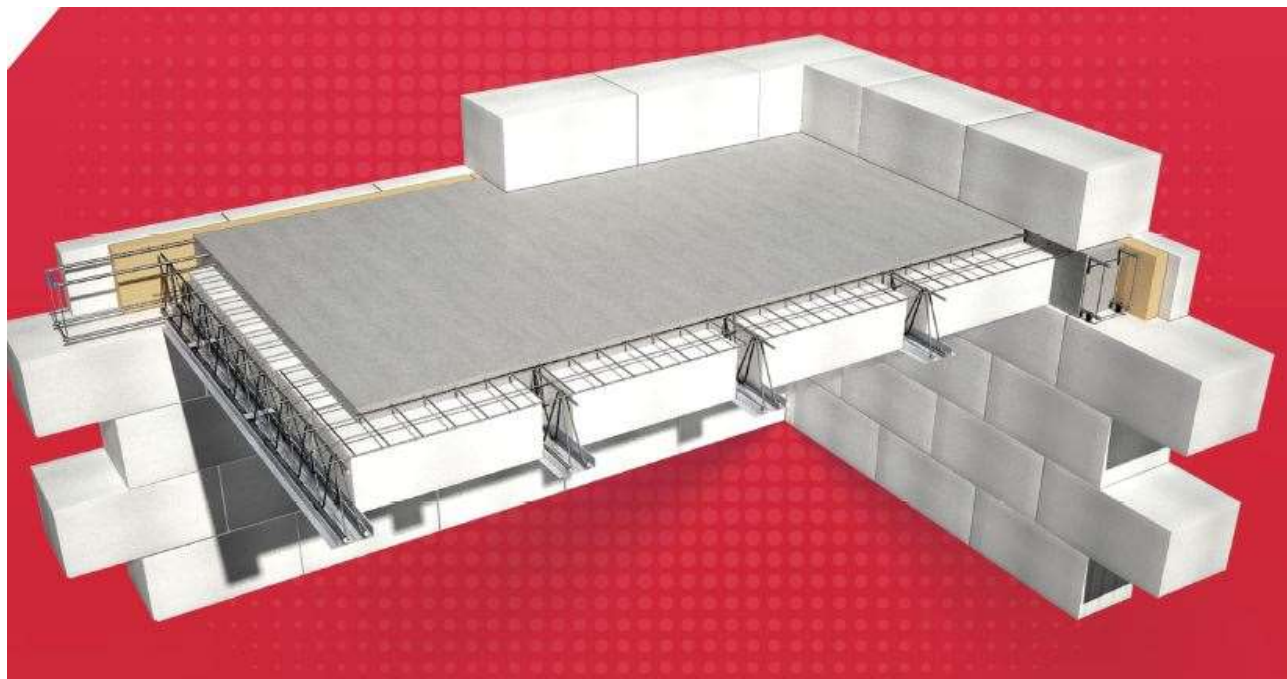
Сборно-монолитное перекрытие МАРКО-ЛСР с применением газобетонных блоков.
